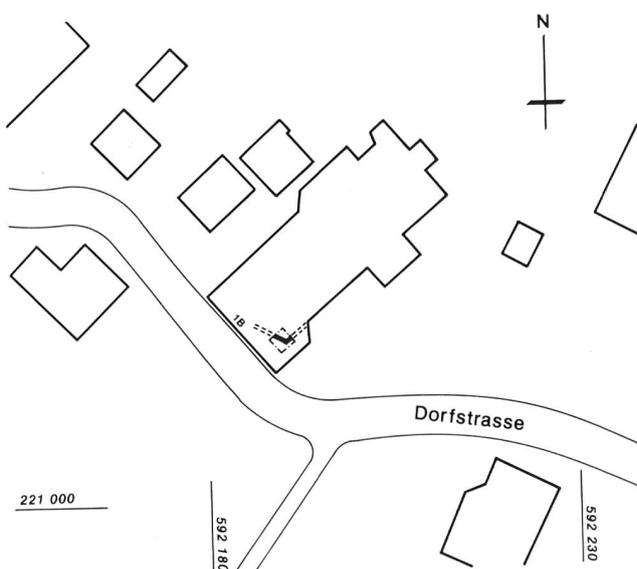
Meienried, Dorfstrasse 1b. Situationsplan M. 1:1000 mit Mauerbefund.
